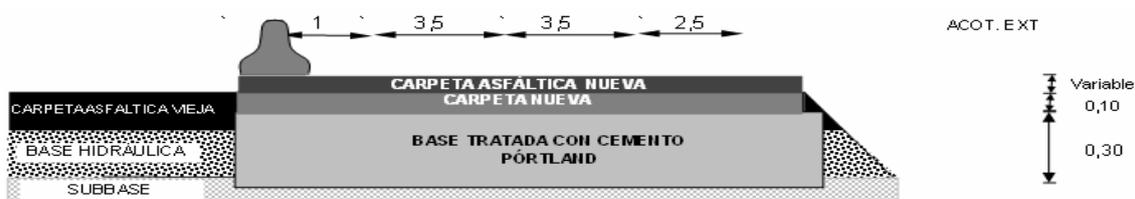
Segunda alternativa de pavimento flexible. La mejor opción para controlar los asentamientos
